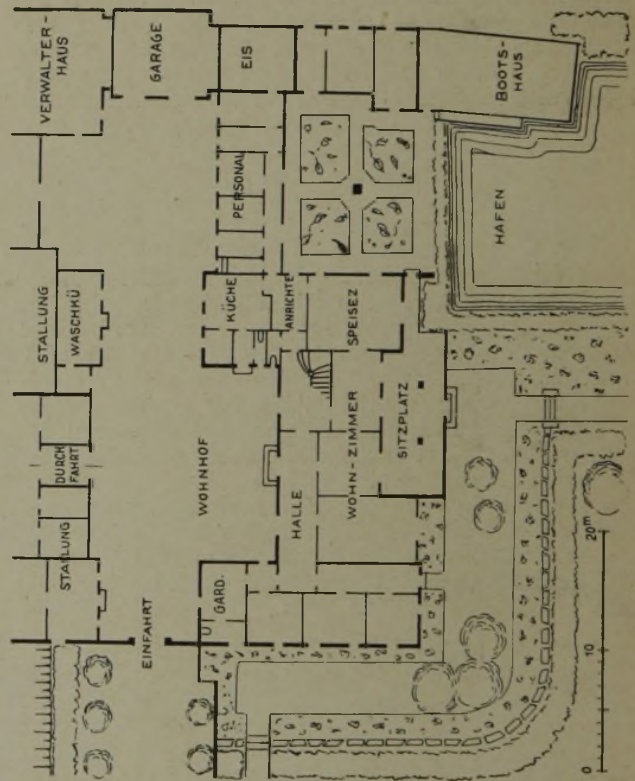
Wohnhausgrundriß vom Erdgeschoß. (1 : 625.)
